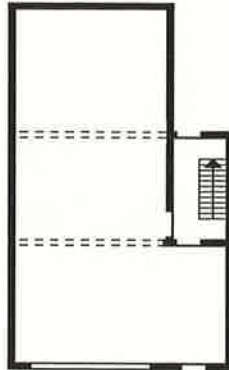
, Typischer Um- und Ausbau eines Gebäudes mit einem Laden, welcher zu einem "weichen" Erdgeschoss (soft storey) führt
